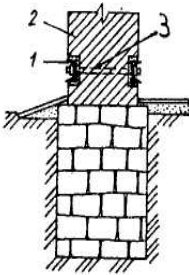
Повне розвантаження фундаменту поздовжніми балками:
